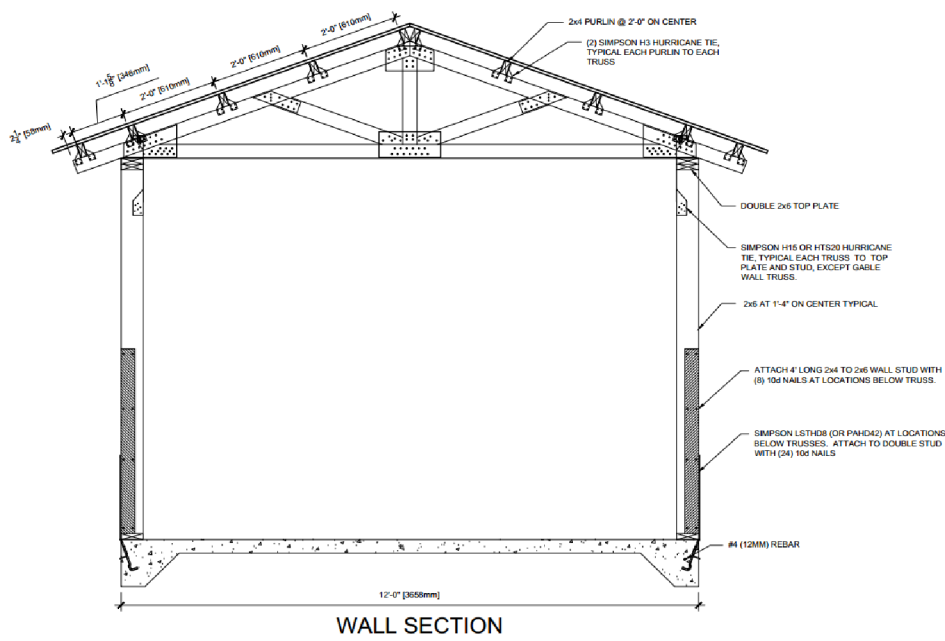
Desenhos técnicos do abrigo, corte construtivo.
